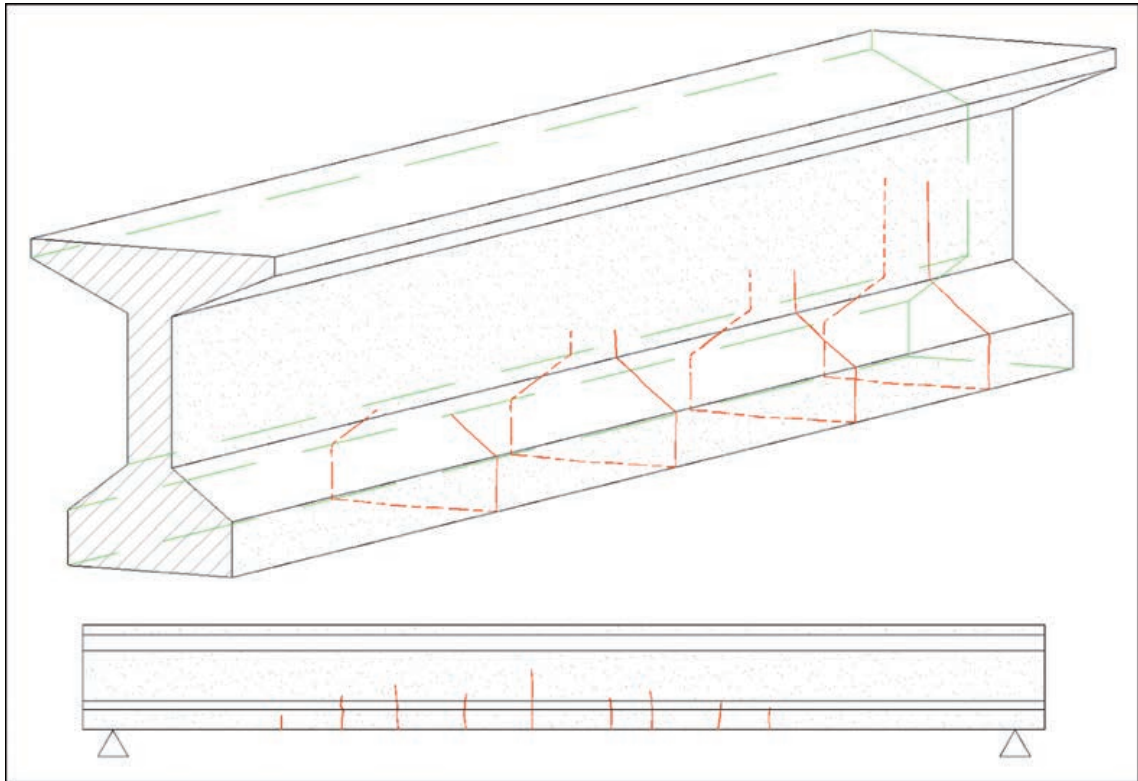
FISURAS EN CABEZA O PATÍN INFERIOR DE VIGA DOBLE T.
